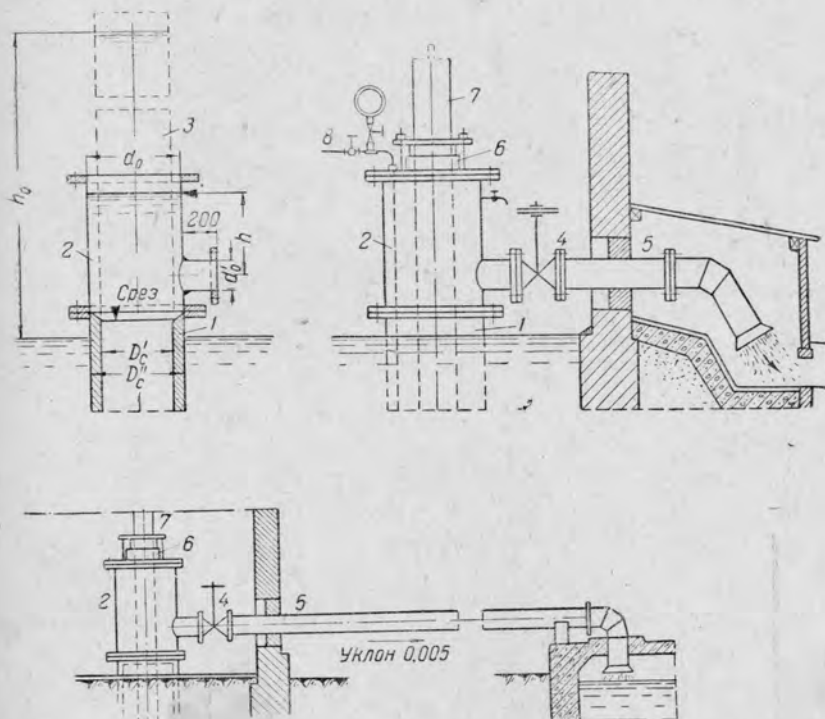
Оголовок самоизливающейся скважины для установки вертикального центробежного насоса:
